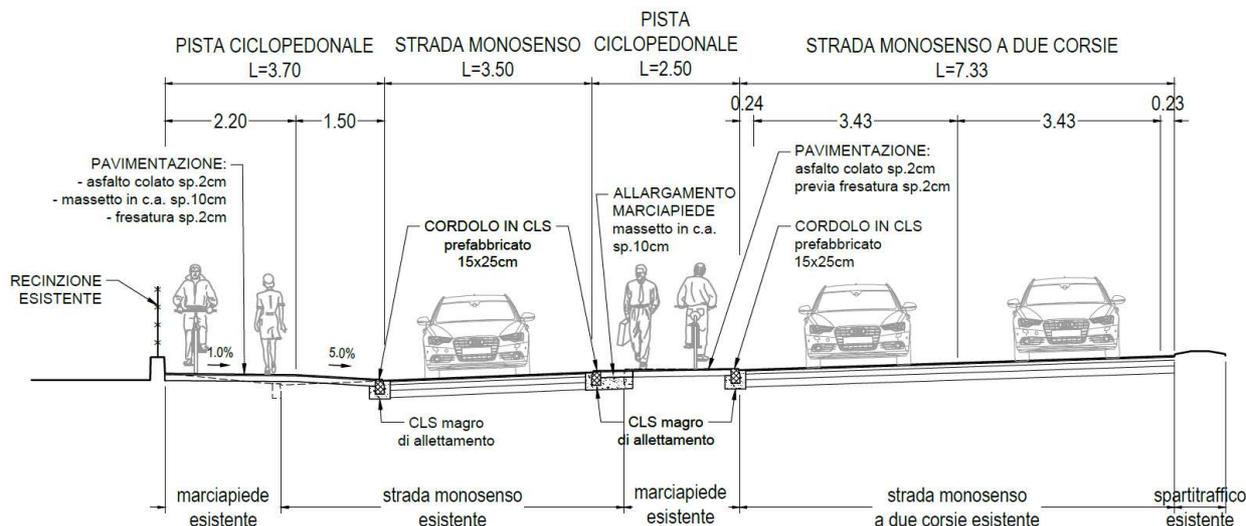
Sezione tipo attraversamento ciclopedonale su Strada Beneceto
